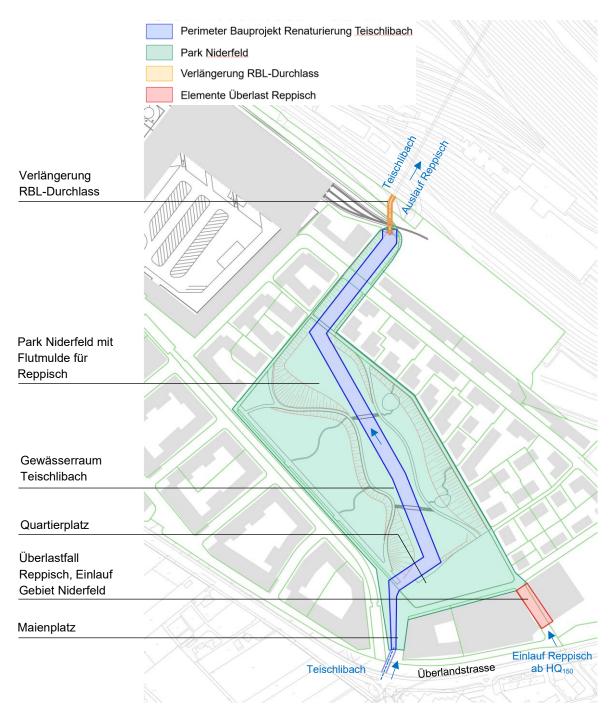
Projektperimeter, Projektelemente und Schnittstellen zum Quartierplan
